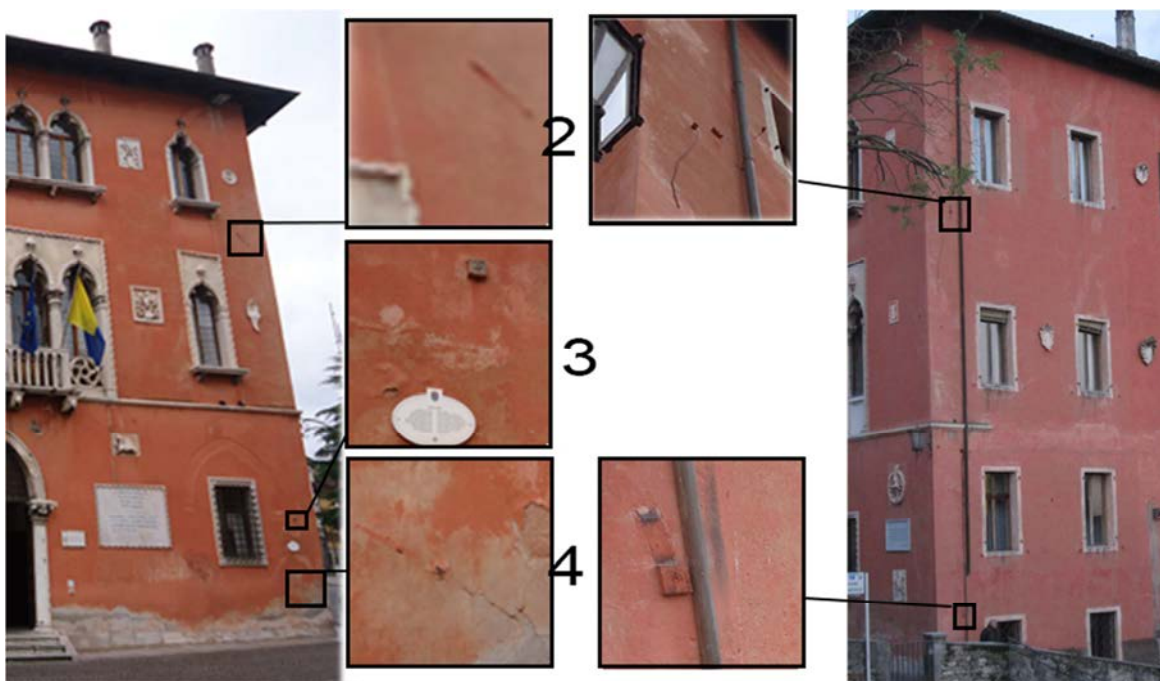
Individuazione sulle facciate dei capochiave dei tiranti supposti in direzione trasversale rispetto alla lunghezza dell'edificio.
